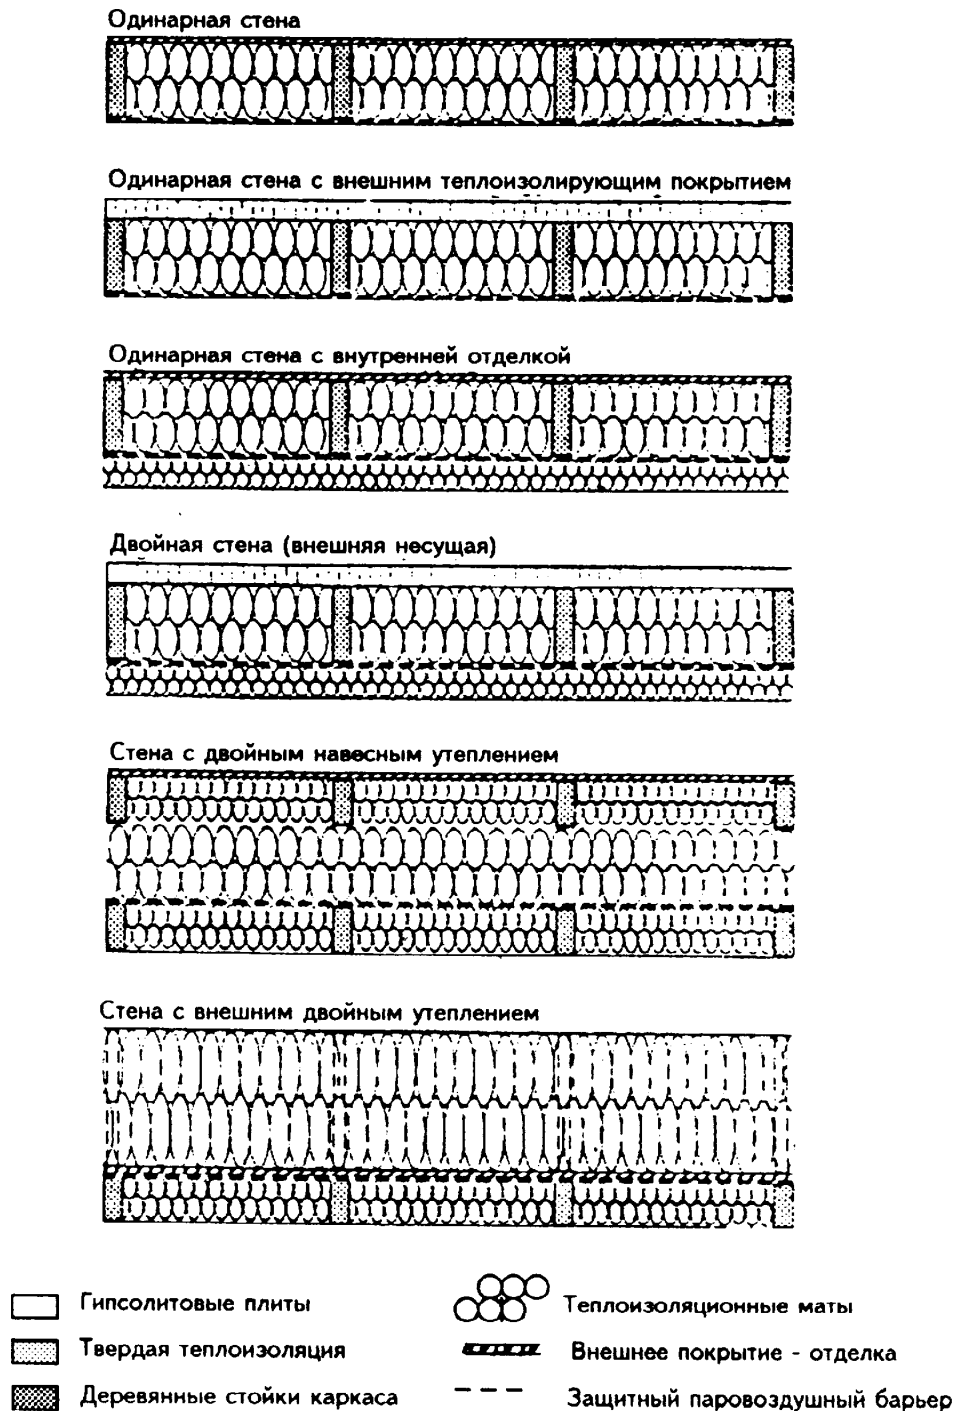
Примеры конструкции утепленных стен в каркасном типе домов
